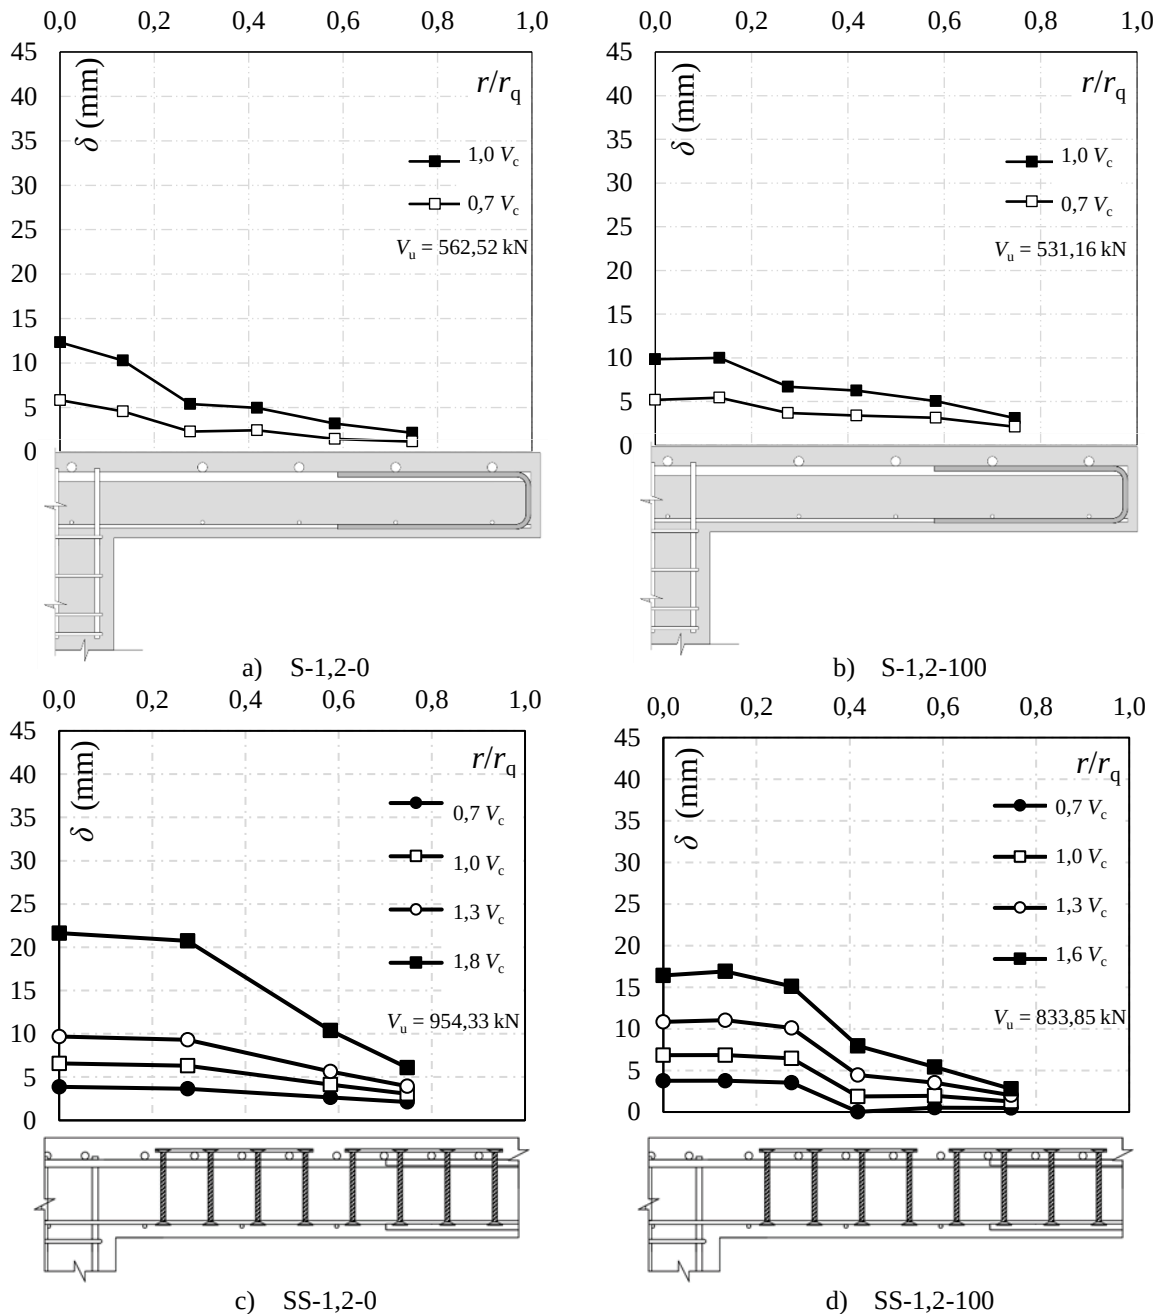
Perfil carga-deslocamento das lajes testadas e lajes de referência
